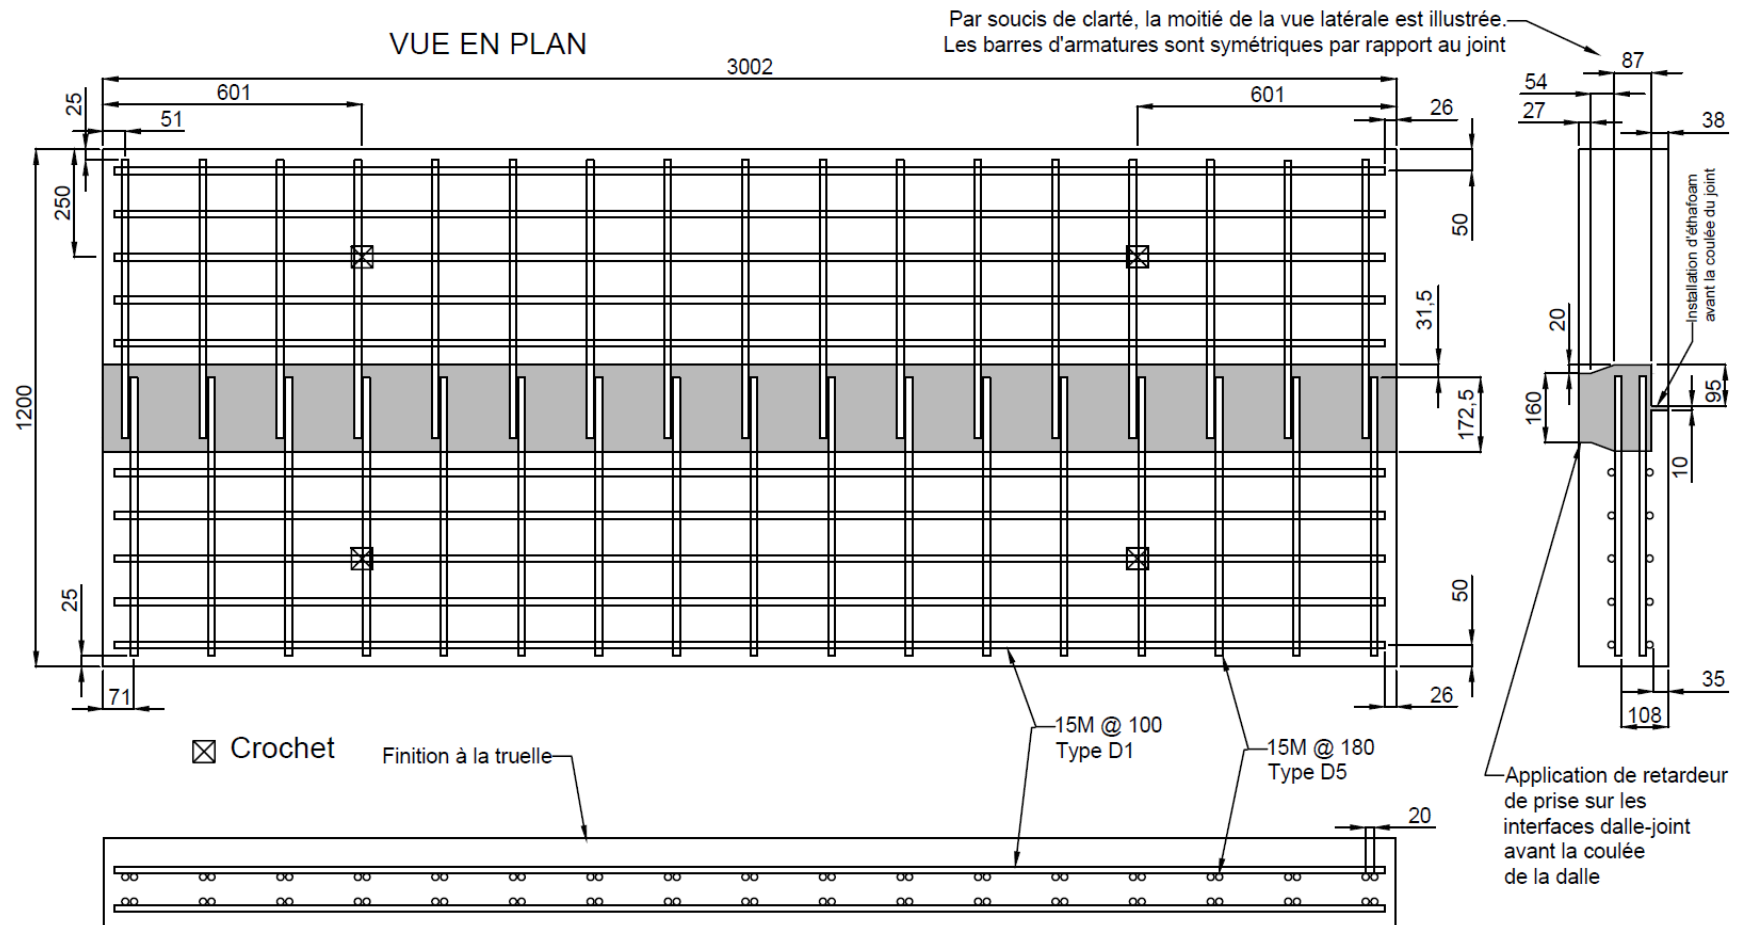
Dalle en BHP avec joint de connexion transversale (TQC) pour le test cyclique (#2.2)
